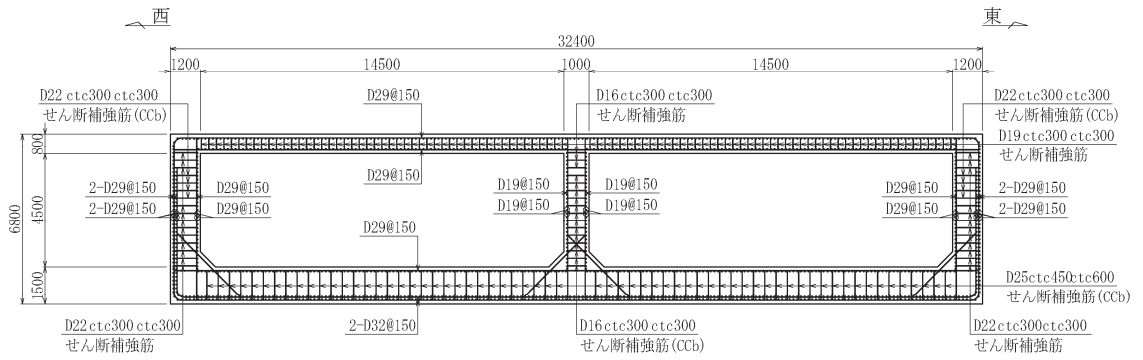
軽油タンク室概略配筋図 (B-B 断面, 東西 (タンク室))
